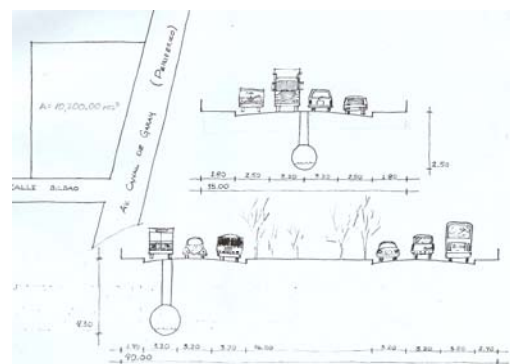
secciones de las calles, ubicando el drenaje y su profundidad.
